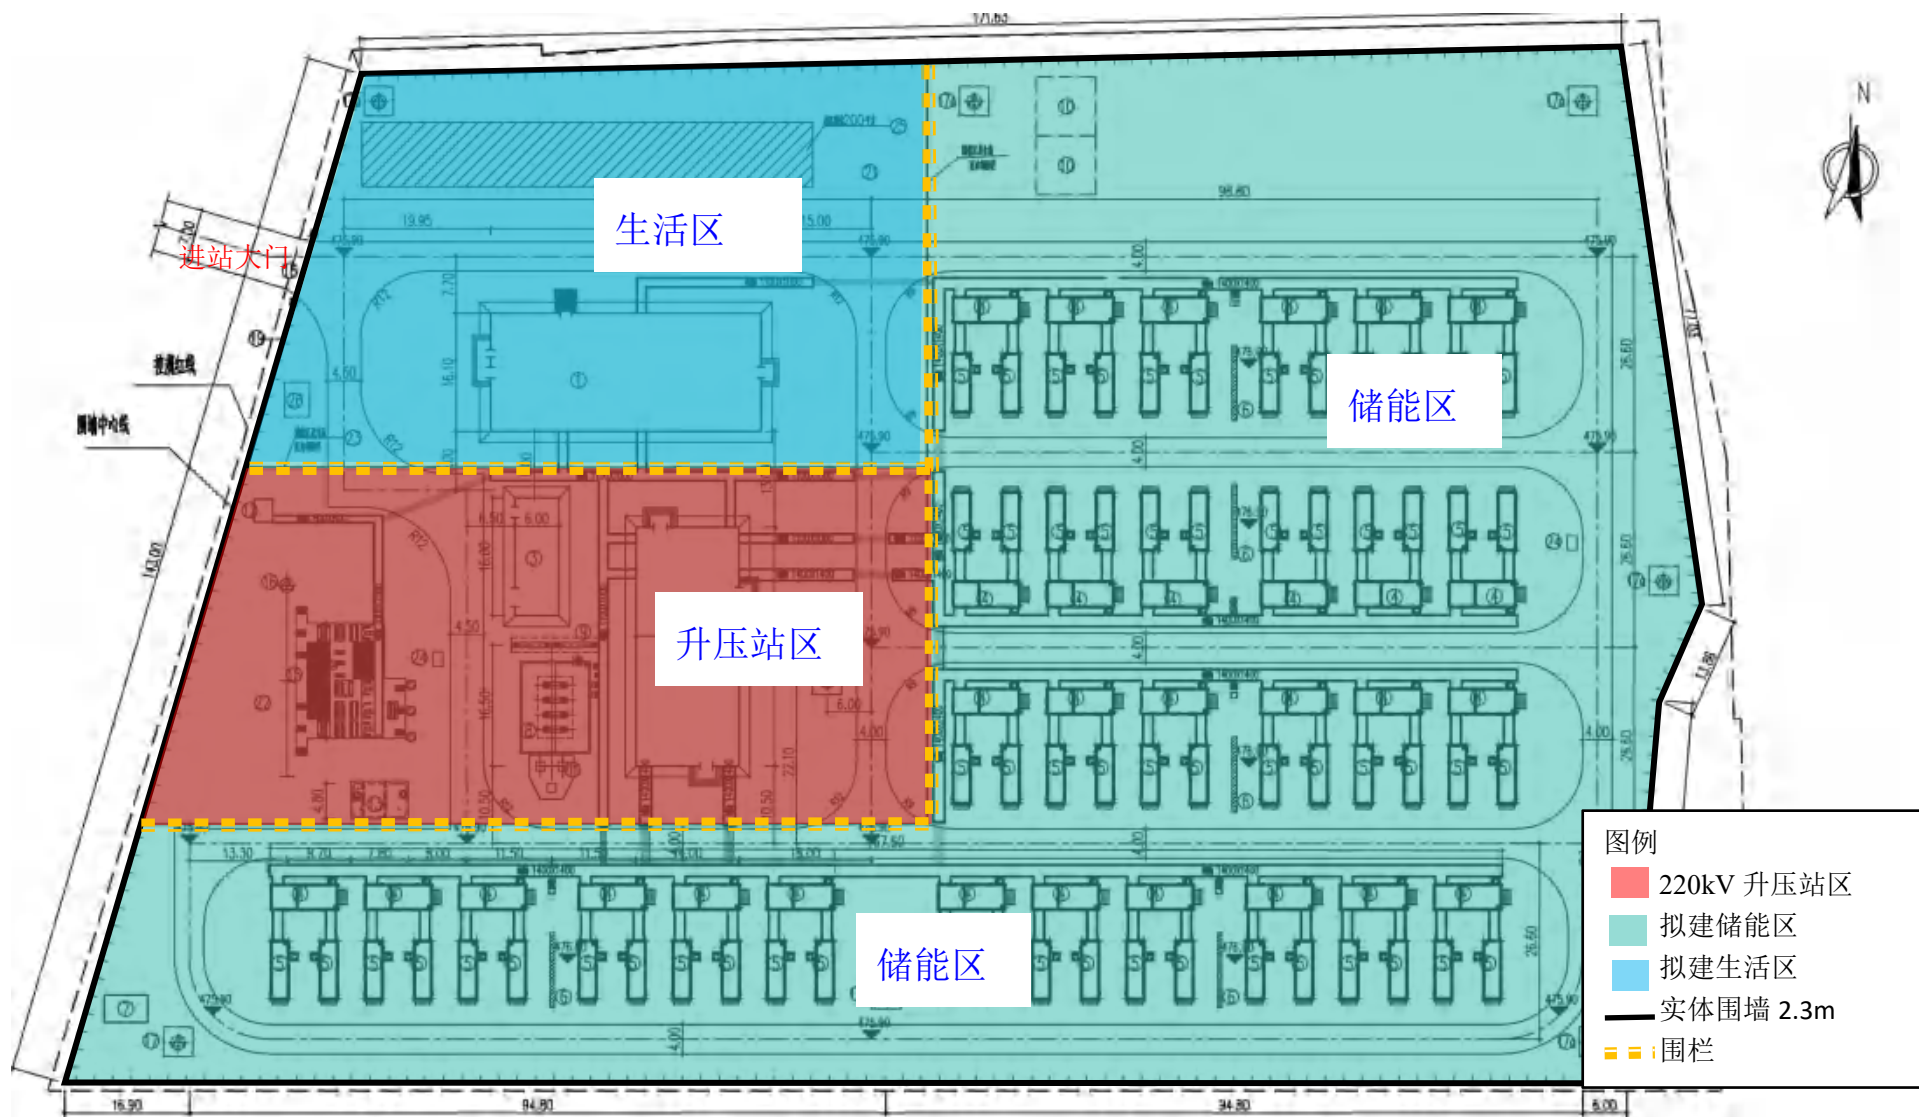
三门峡市湖滨区 200MW/400MWh 共享储能电站总平面布置图
